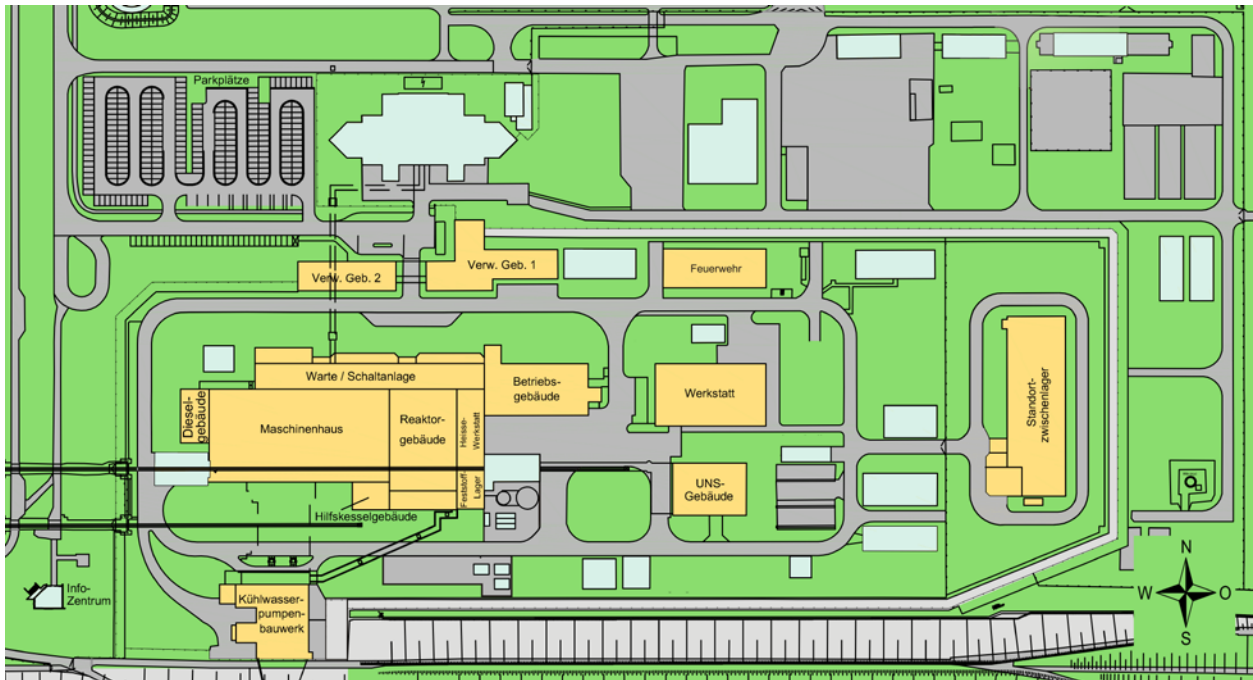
3: Lageplan des Kernkraftwerks Brunsbüttel
